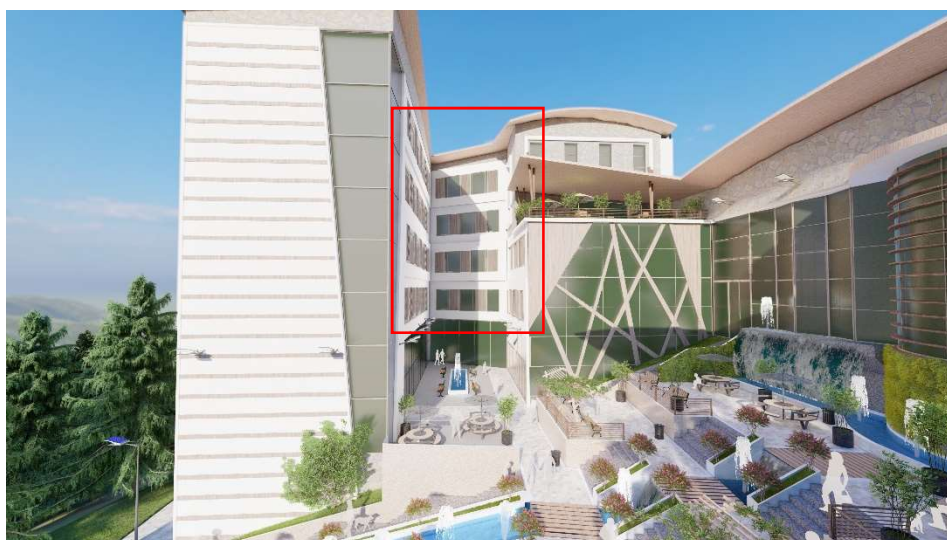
positionnement des brises soleil horizontaux dans la façade intérieur (source : auteur)
